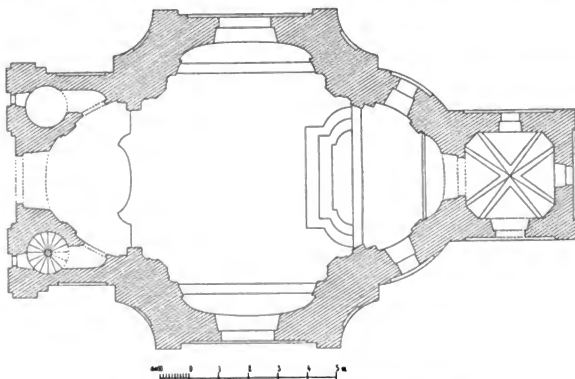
Radnitz. Grundriss der Kirche auf dem Calvarienberge.
